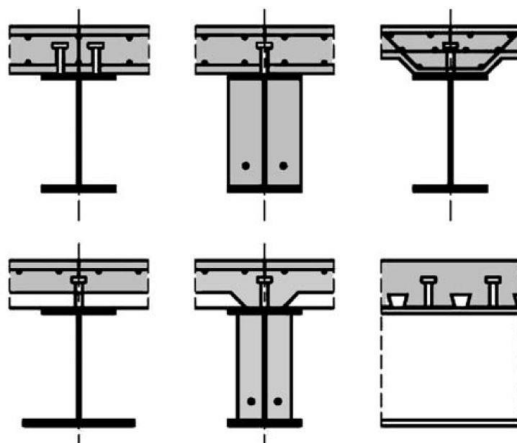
Основні типи поперечного перерізу сталезалізобетонних балок із залізобетонними плитами, що наведені в Eurocode 4
